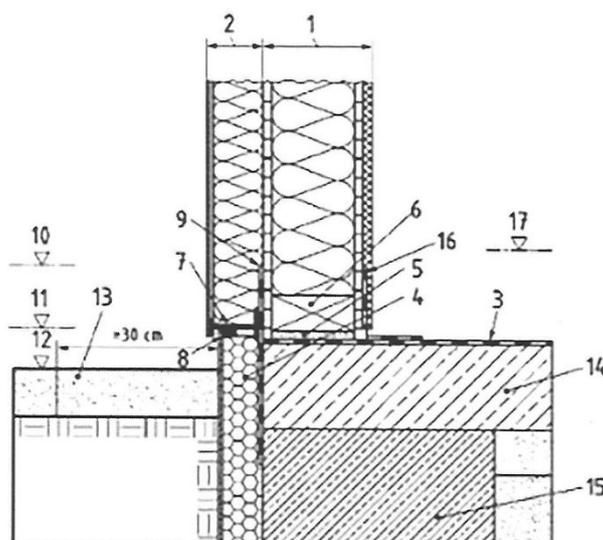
Parete meno distanziata dalla fondazione con letto di ghiaia sulla facciata esterna
